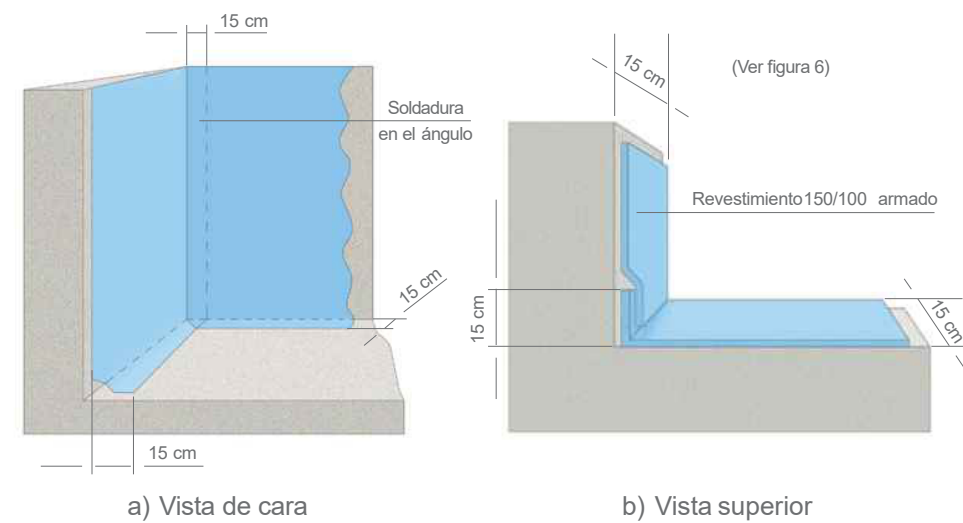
Elaboración de ángulo vertical con perfilado tipo "Hung"
